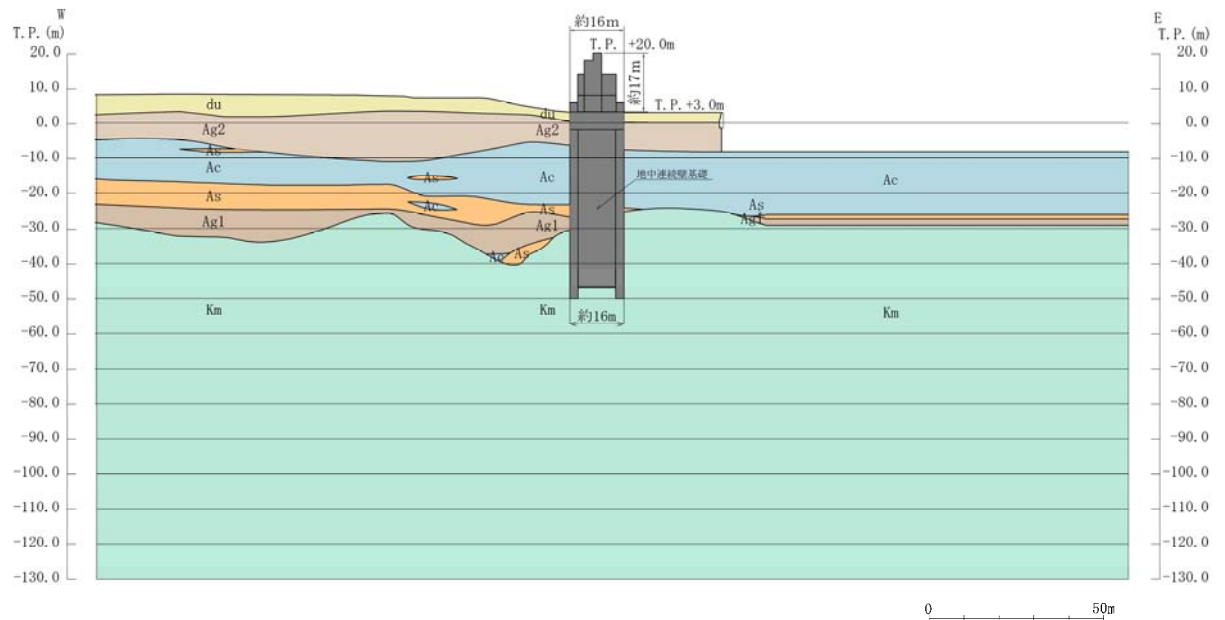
(3) 鋼製防護壁断面図 (③-③断面)
